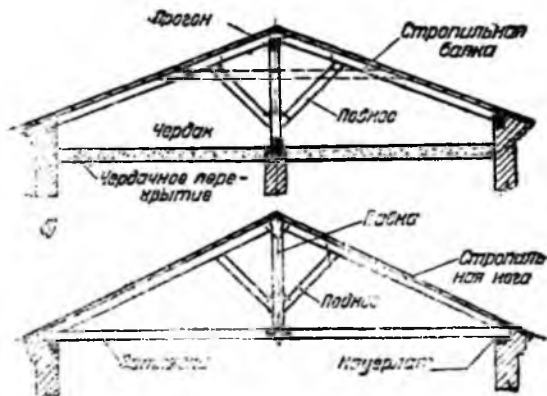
Наслонные и висячие стропила с одной подбабкой
